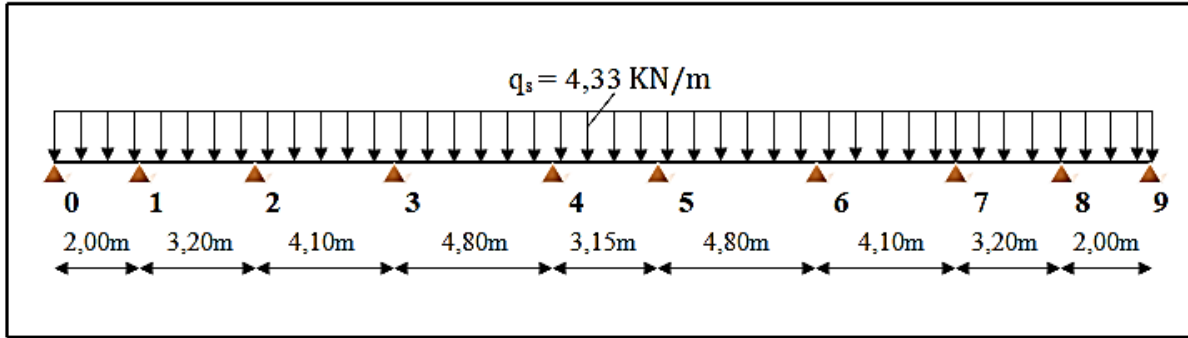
schéma statique des poutrelles à l'ELS (1^{er} cas).
